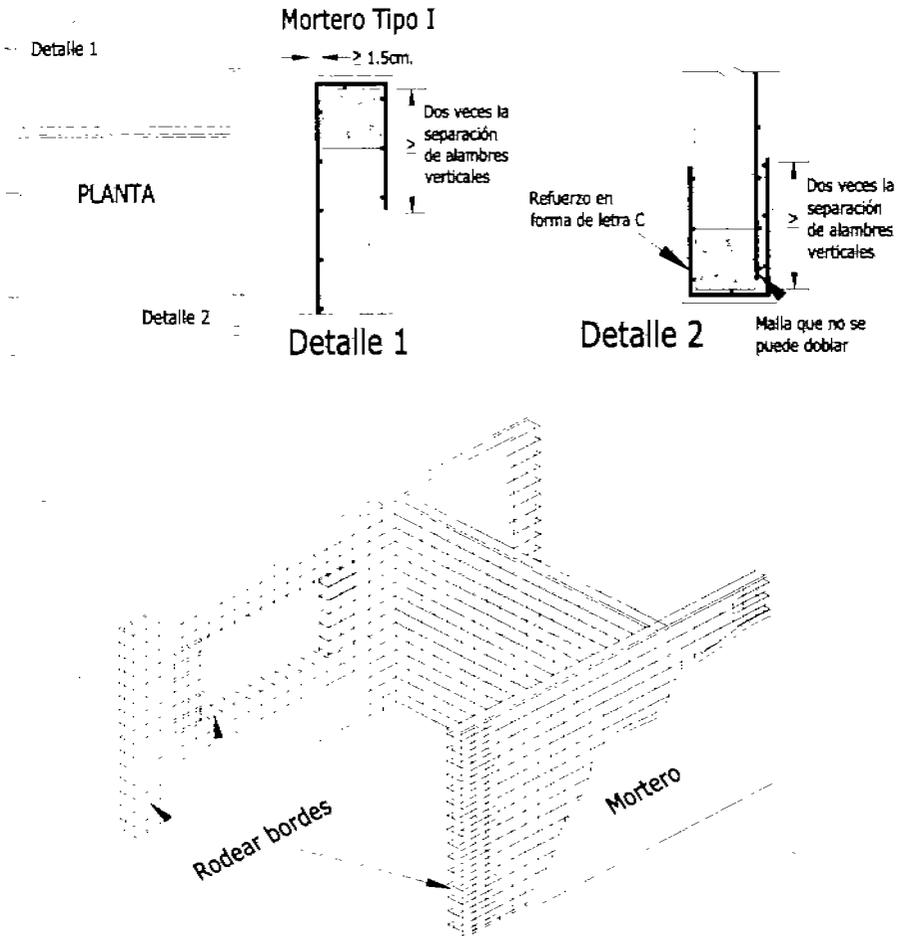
a) REFUERZO CON MALLA DE ALAMBRE SOLDADO Y RECUBRIMIENTO DE MORTERO
